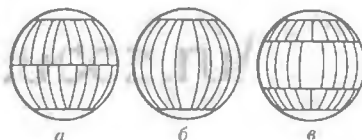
Схеми розкroku корпусів сферичного резервуарів
